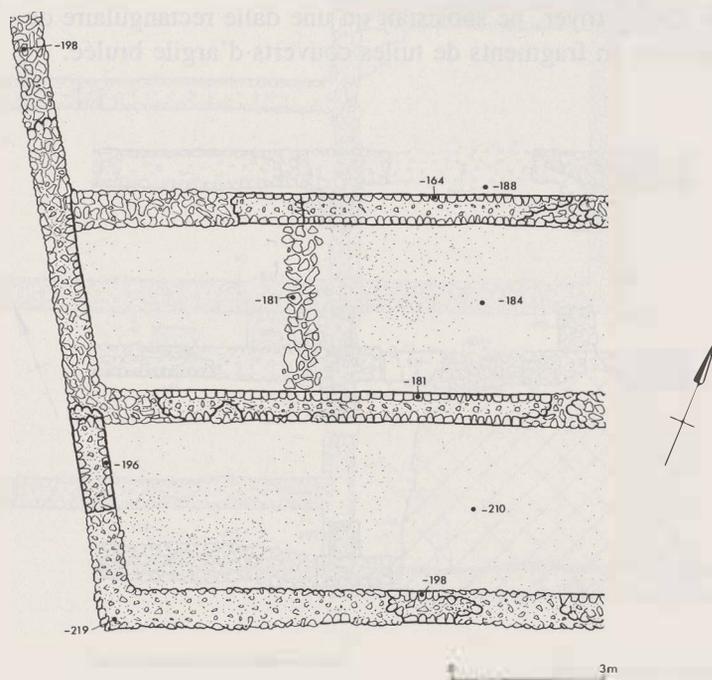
Plan de l'angle sud-ouest de la façade.
